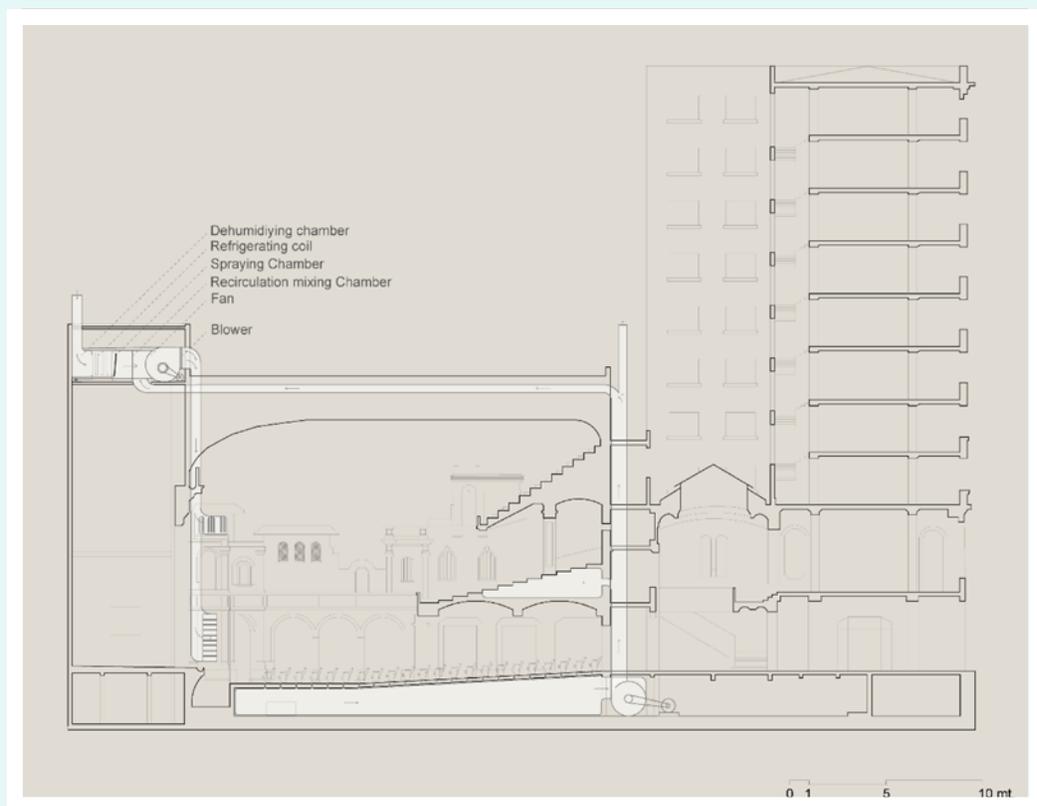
Reconstrucción del sistema de aire acondicionado del Teatro Real. Corte Longitudinal Section. Elaboración propia en base al levantamiento arquitectónico y a las patentes US1583060A y Pat.Ch. 7517-1930.
